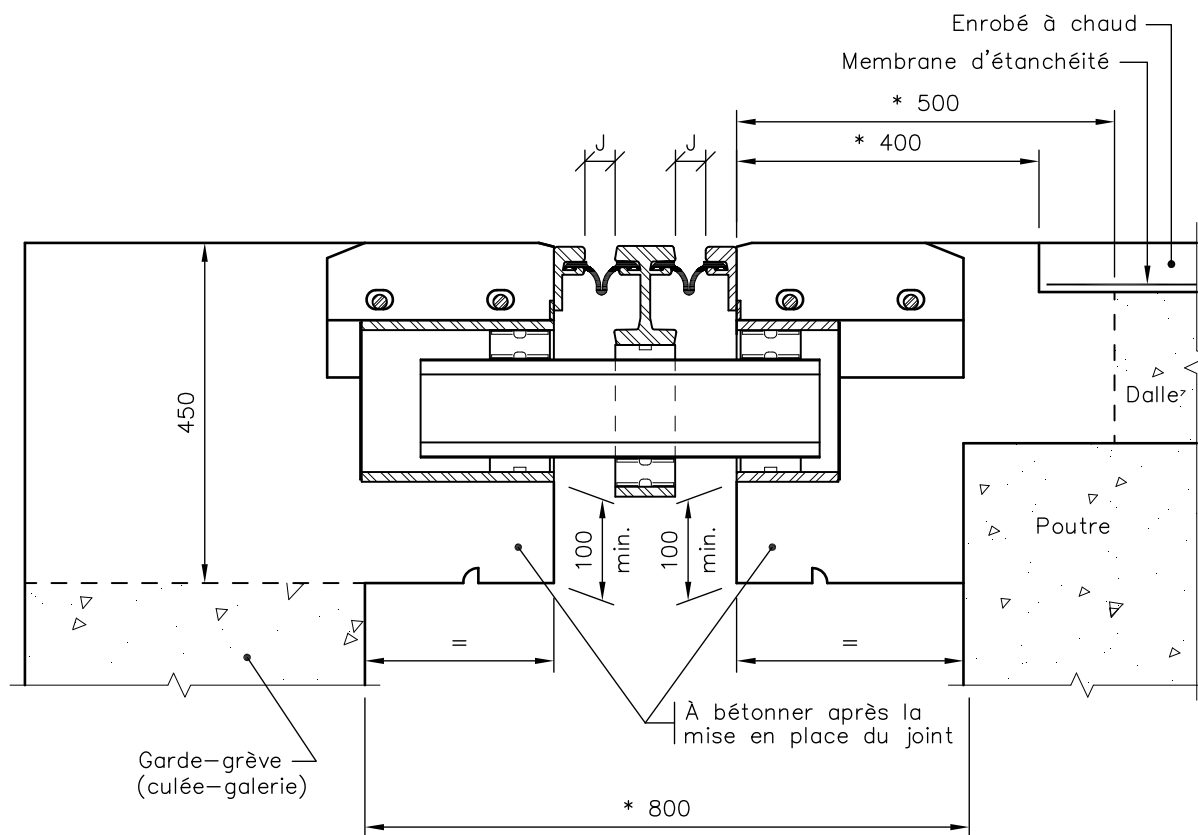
Détail de l'extrémité de la dalle avec joint de tablier
